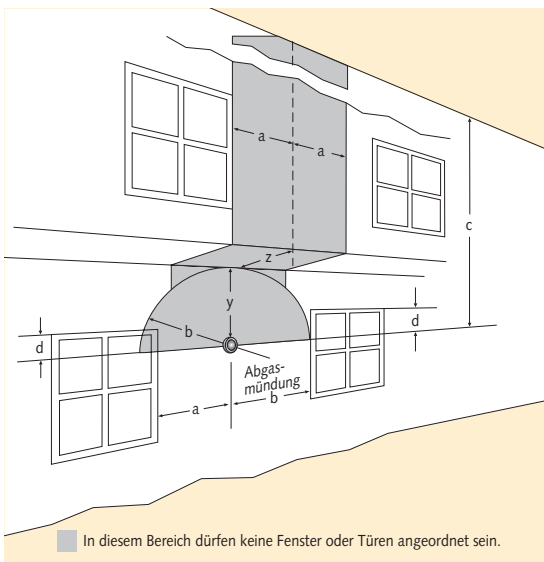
Mindestabstände einer einzelnen Abgasmündung zu Fenstern, die geöffnet werden können oder zu Fassadentüren bei Fassaden mit Vorsprung
